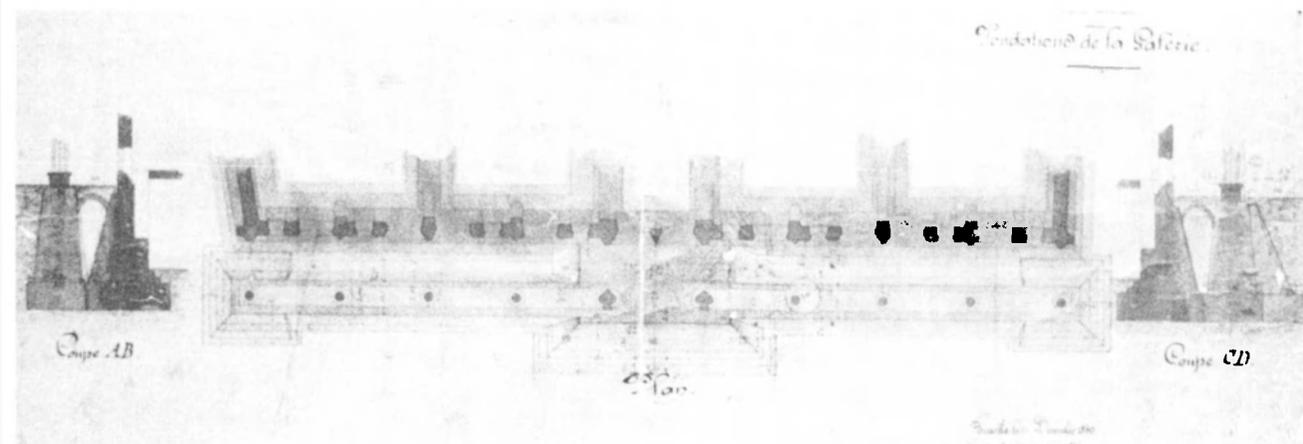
M.d.R., plan de fondation de la galerie, 1880, A.A.V.B.
